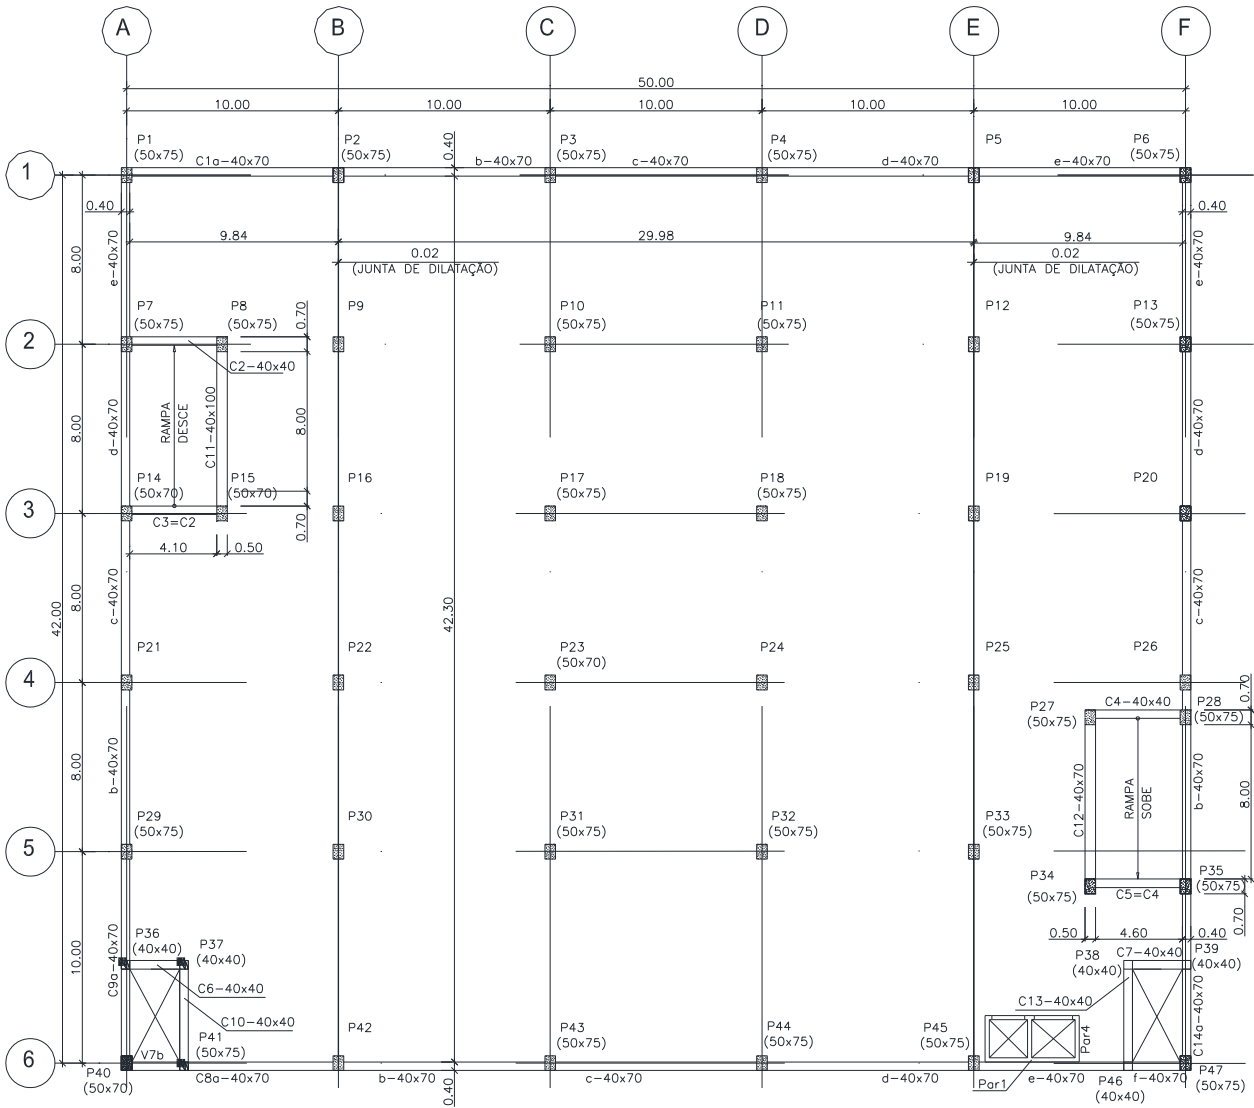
Fôrma – Planta Baixa do 1º ao 4º teto
